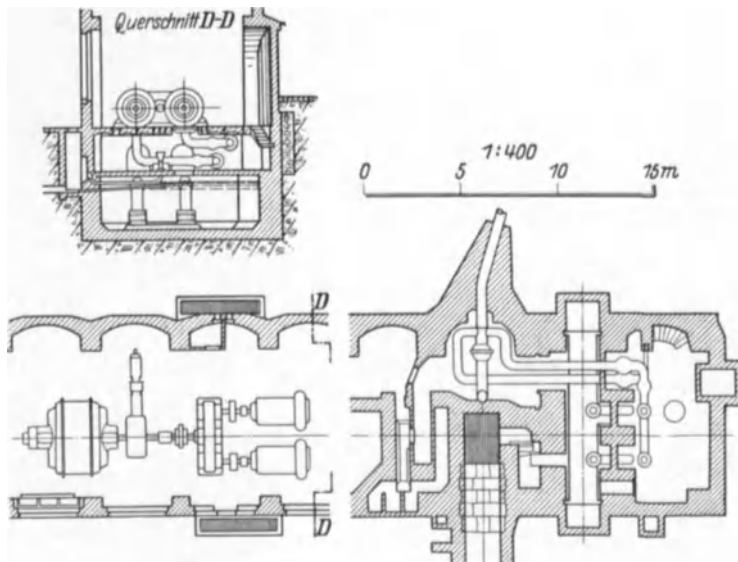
Tremorgiowerk, Grundriß und Schnitt. (Schweiz. Bauztg. 1927, I.)
